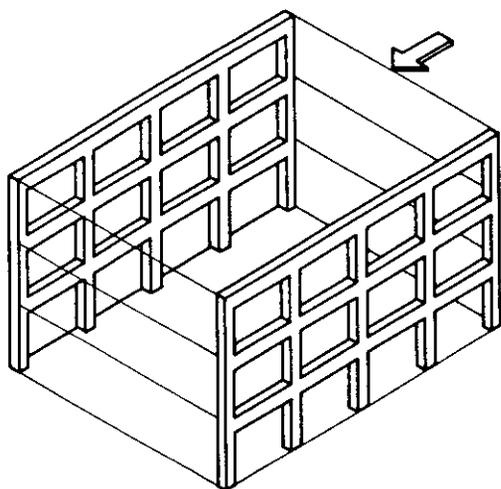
Estrutura em Pórticos Planos (Fonte: Ambrose e Vergun [18])
